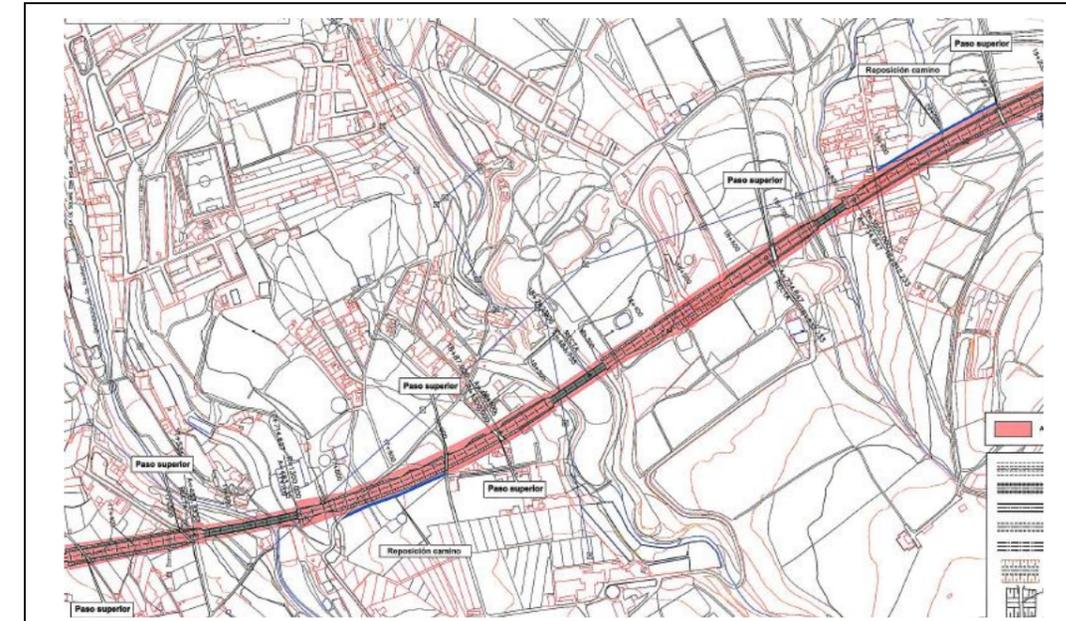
Imagen planta de 7 pasos superiores previos a la estación de Telde PTE-21
